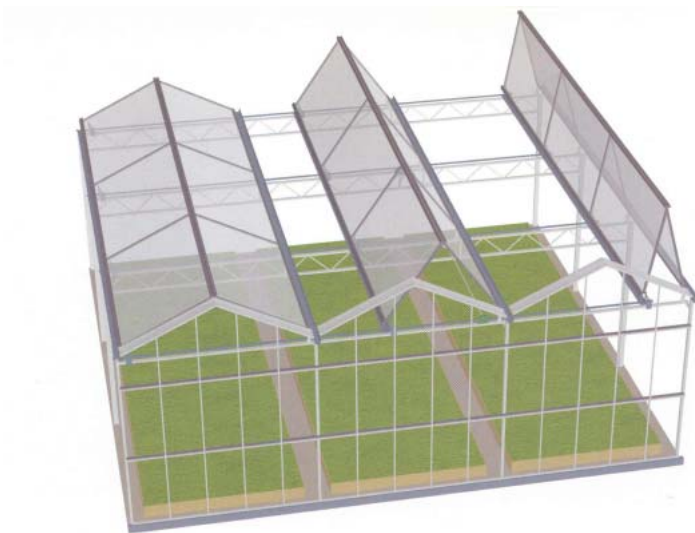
Een regenkap-constructie bestaande uit alleen een dek (Rovero).
